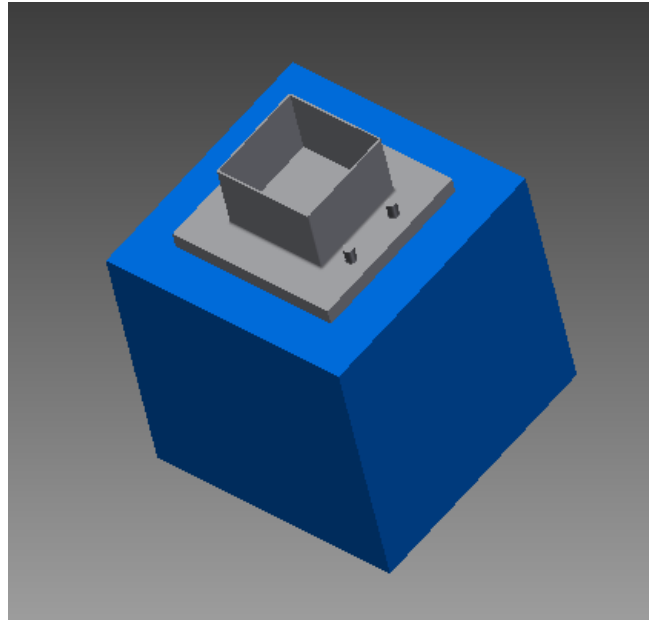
ESQUEMA CONEXIÓN COLUMNA PLACA BASE
